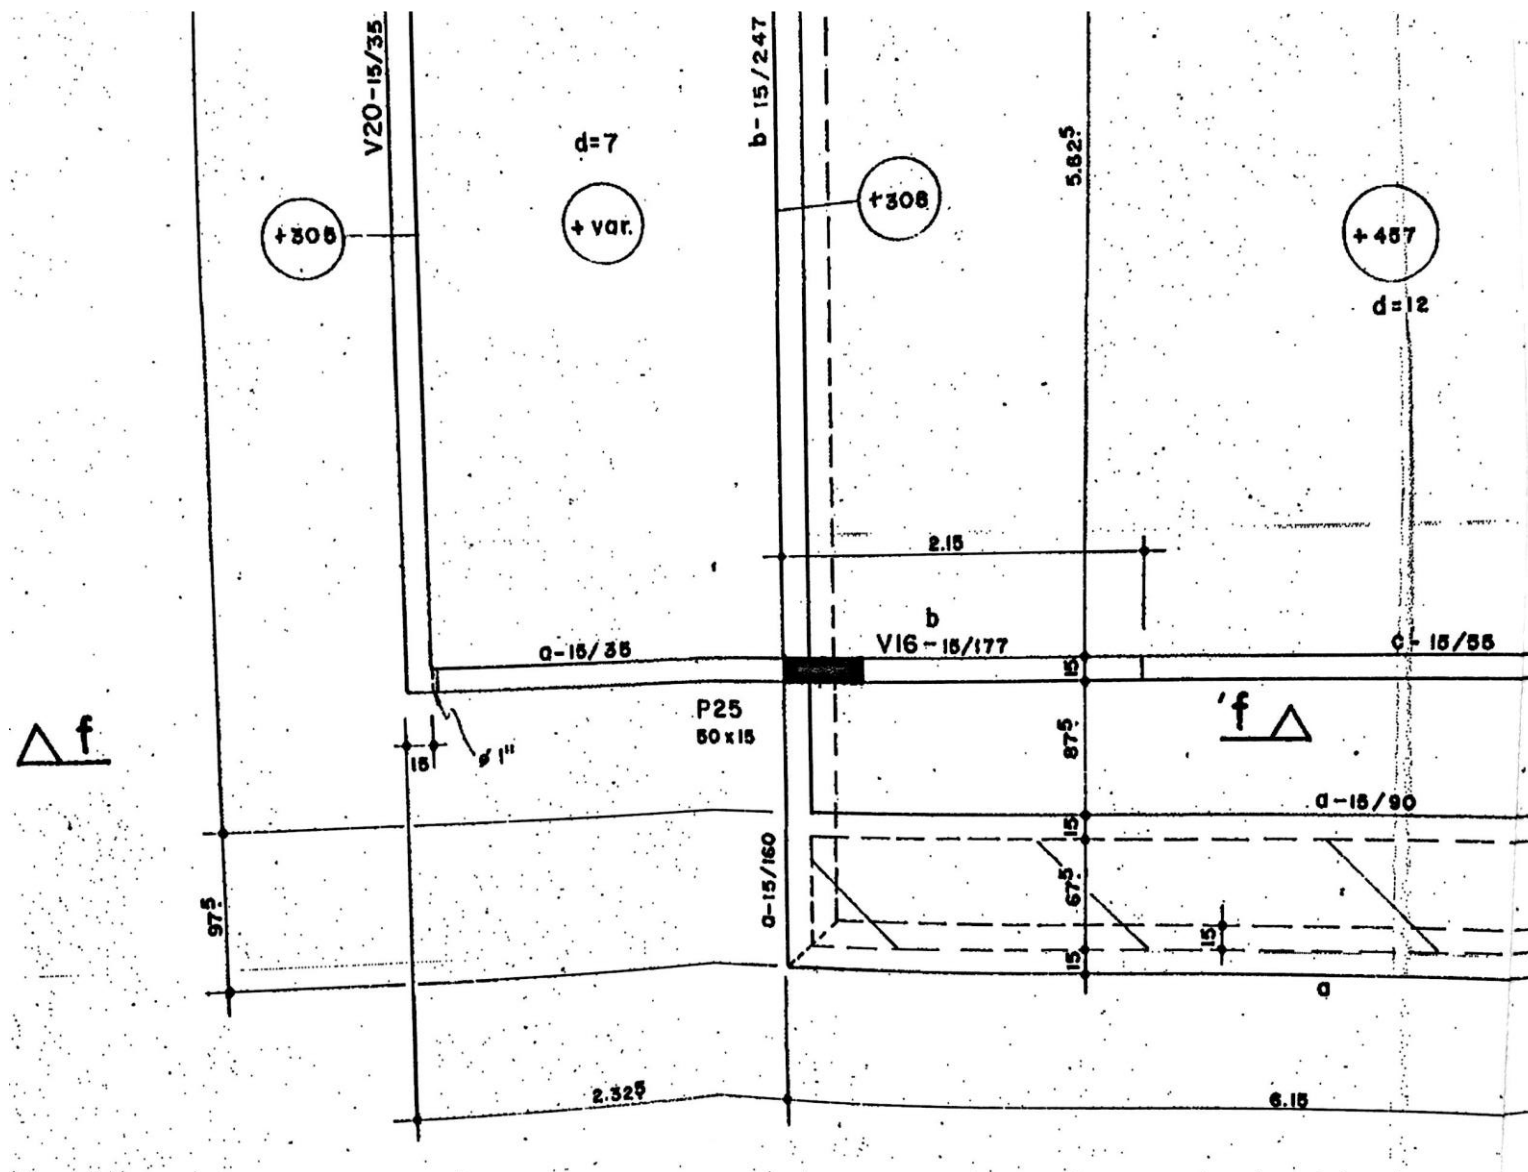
Reprodução parcial da planta de formas da Cobertura
